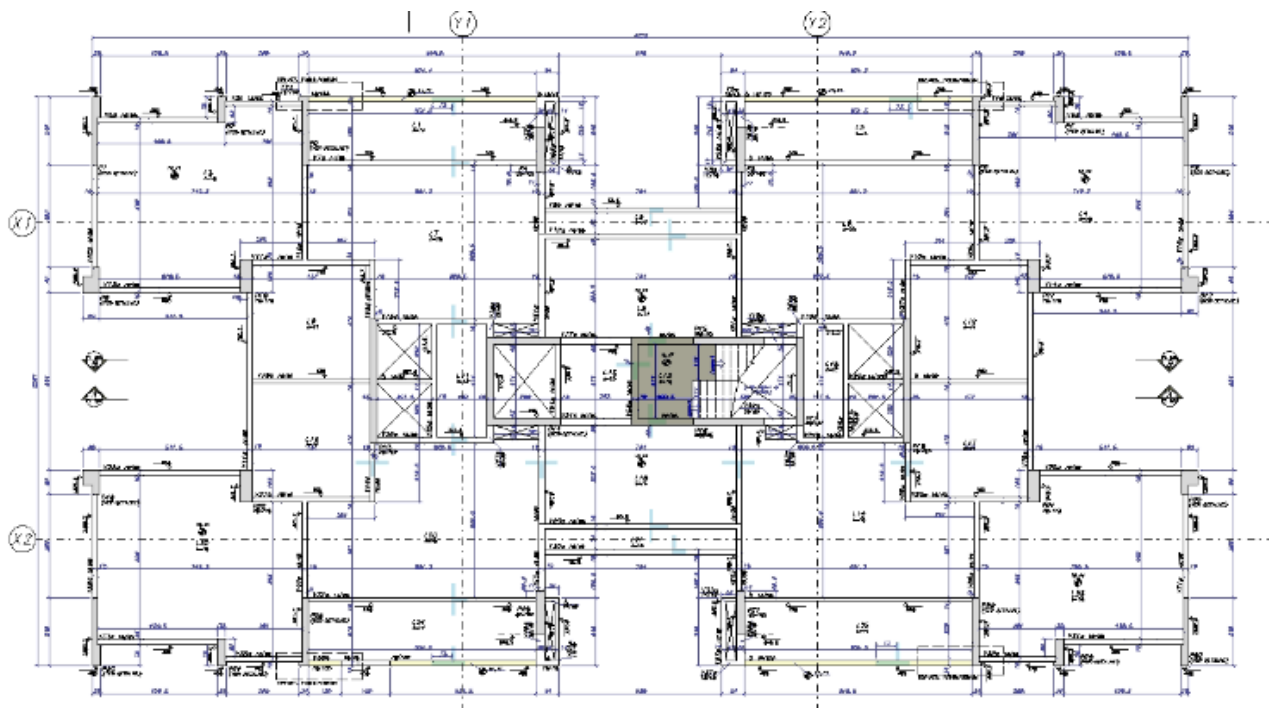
Fôrma do tipo (2º ao 17º pavimento)
